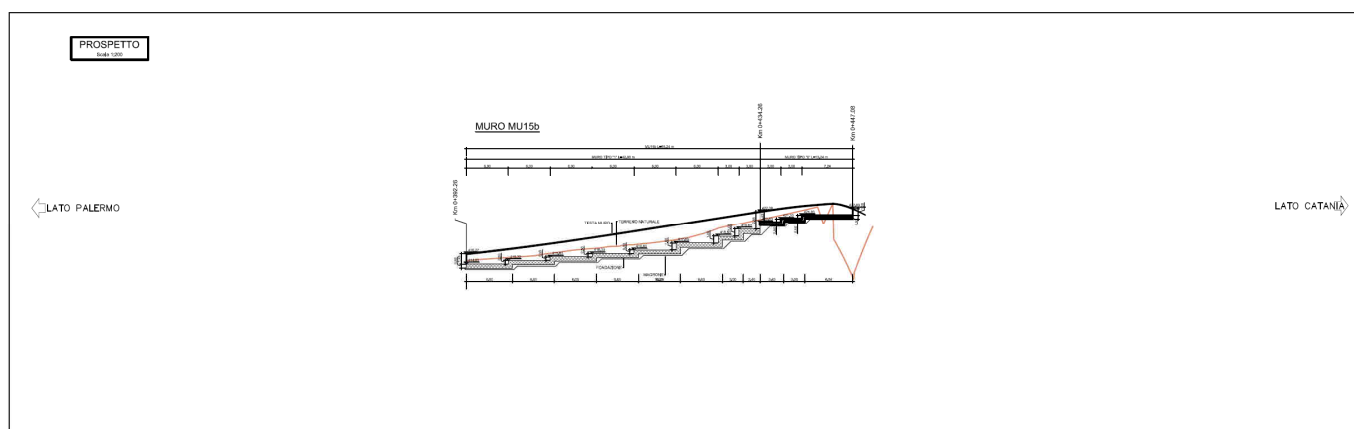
NV04E: Muro di sostegno MU15B - Prospetto.
